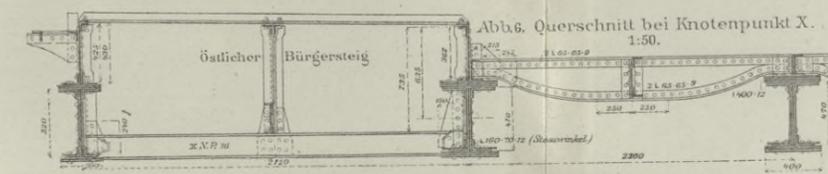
Querschnitt bei Knotenpunkt X. 1:50.
